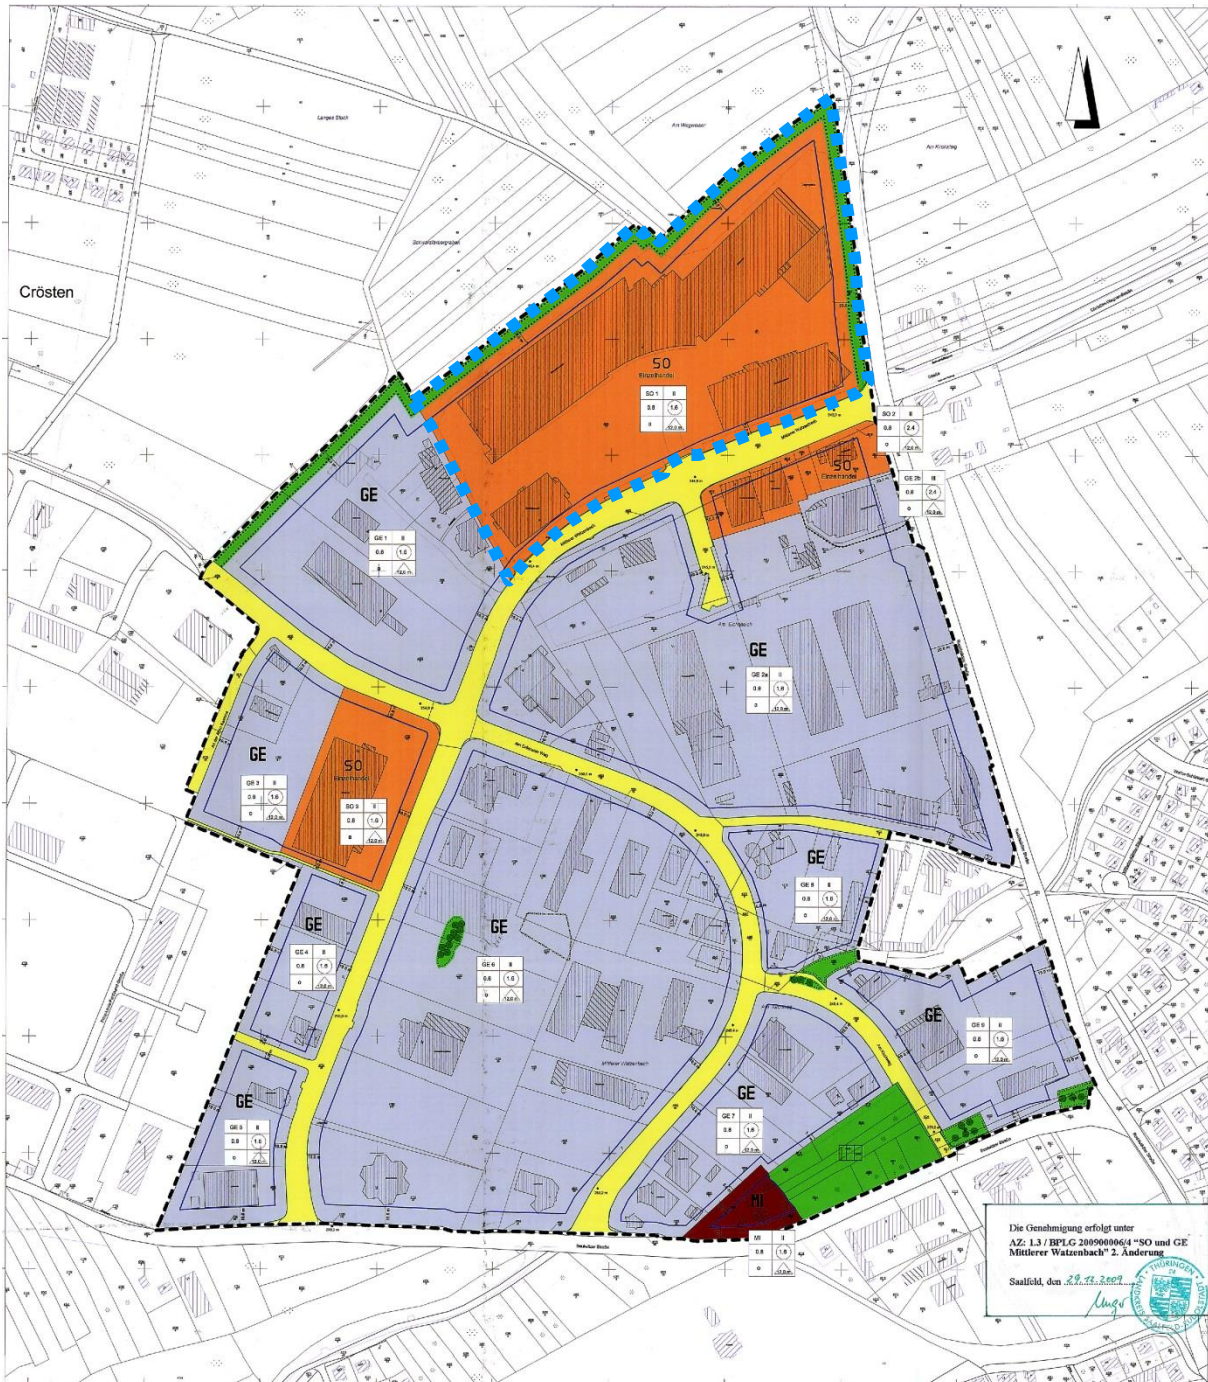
genehmigter Bebauungsplan (in Kraft seit 27.01.2010) mit Geltungsbereich der Änderung (blaue Kästchen)
